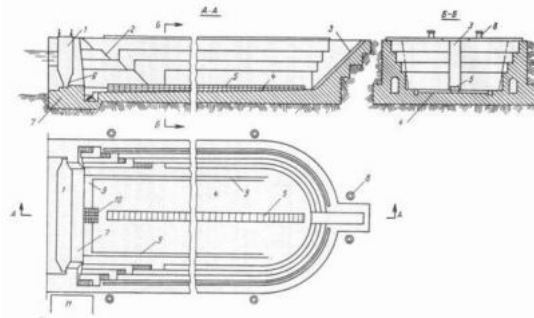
Сухой док. 1 — батопорт; 2 — трапы для спуска в док; 3 — шлюз для спуска грузов; 4 — подошва дока; 5 — килевая дорожка; 6 — привальный брус батопорта; 7 — порог дока; 8 — швартовные битенги; 9 — сточные кюветы; 10 — приемный колодец; 11 — насосная отливная станция [1]
